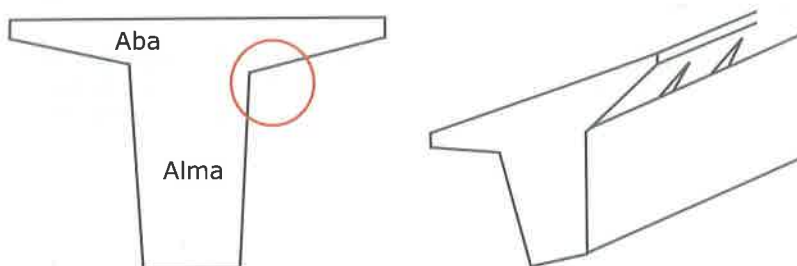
Fissuras em elemento estrutural de seção variável
